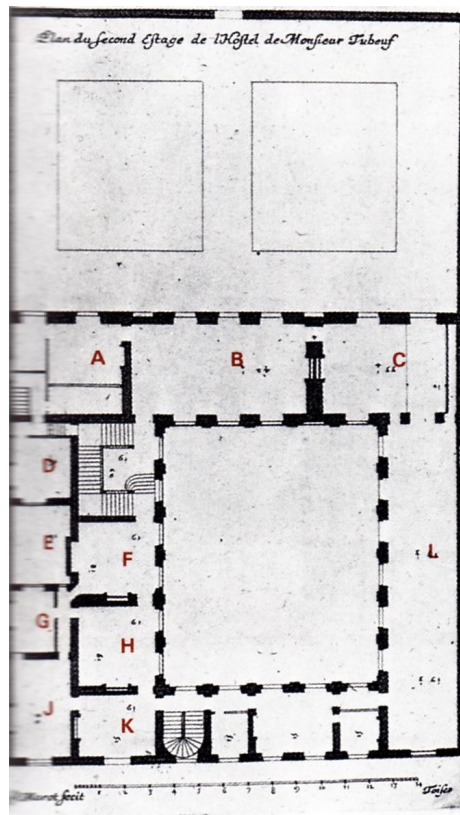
Planta del 2º piso del Hotel M. Tubeuf, 1635. Arquitecto: Pierre Le Muet.
